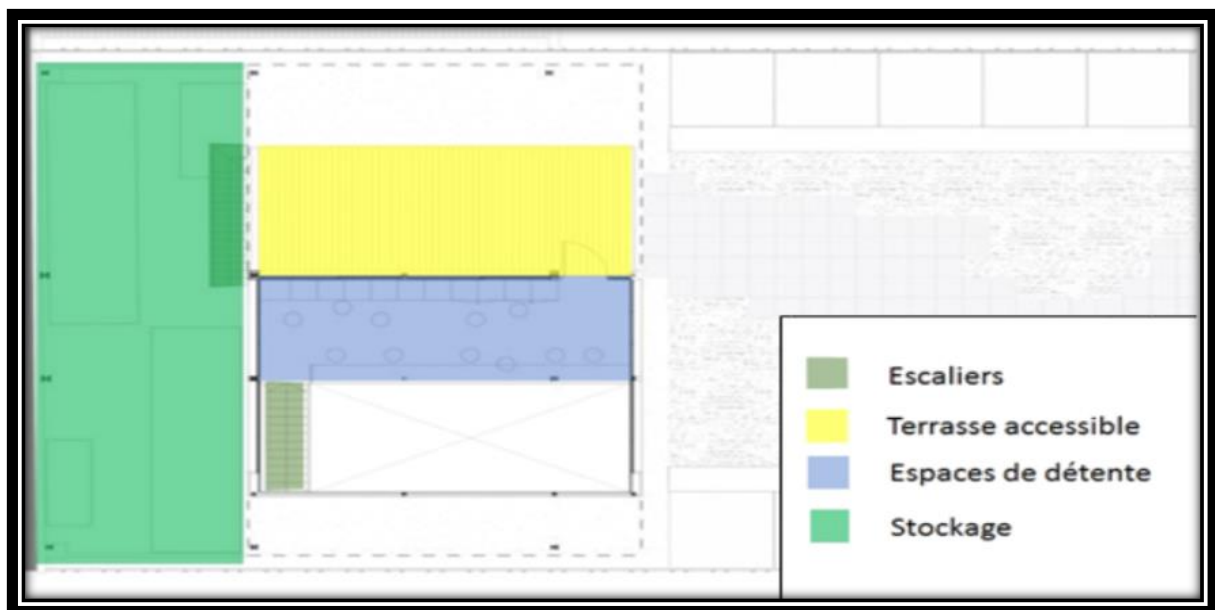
plan du 6^{ème} étage, source : Pinterest.
